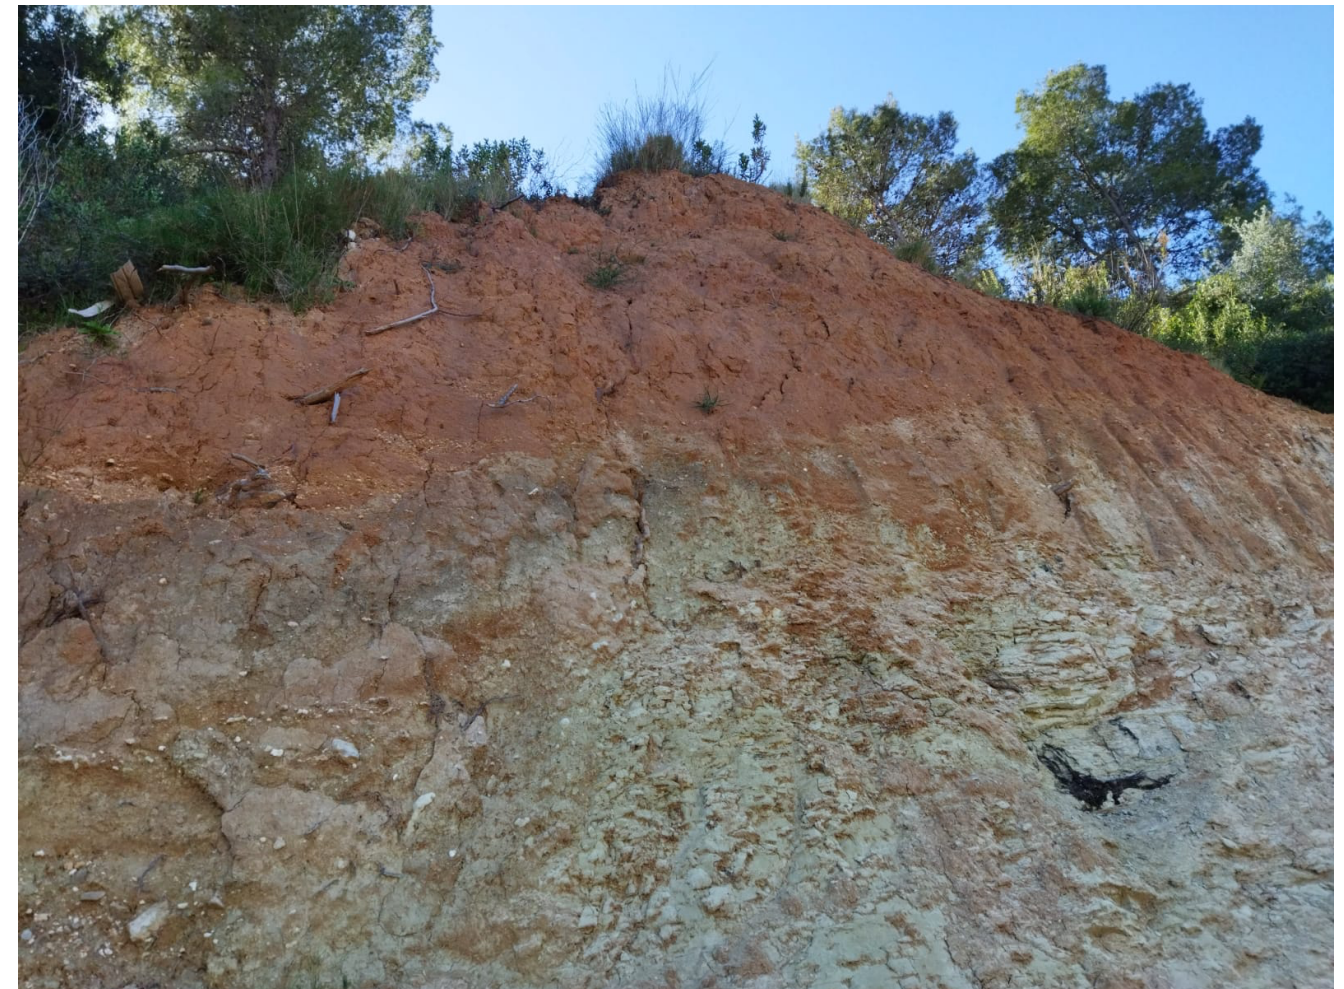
Fisuras de las margas en la zona de la berma. Fuente: Elaboración propia.
